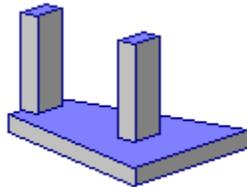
Zapata Combinada, Concreto, Trapezoidal, Colindante
